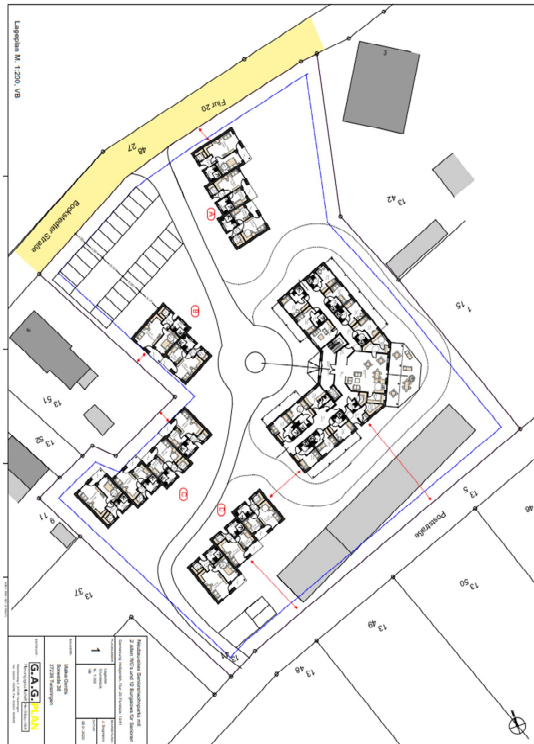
Grundriss EG des Vorhabenkonzeptes des westlichen Teils des Geltungsbereiches
